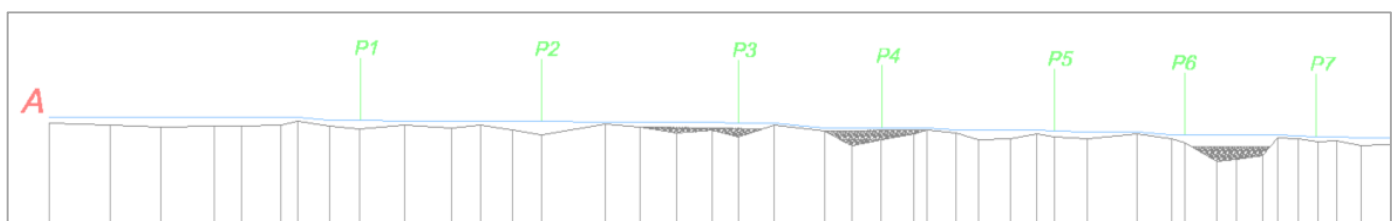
Interventions ponctuelles sur le profil en long en état projet
